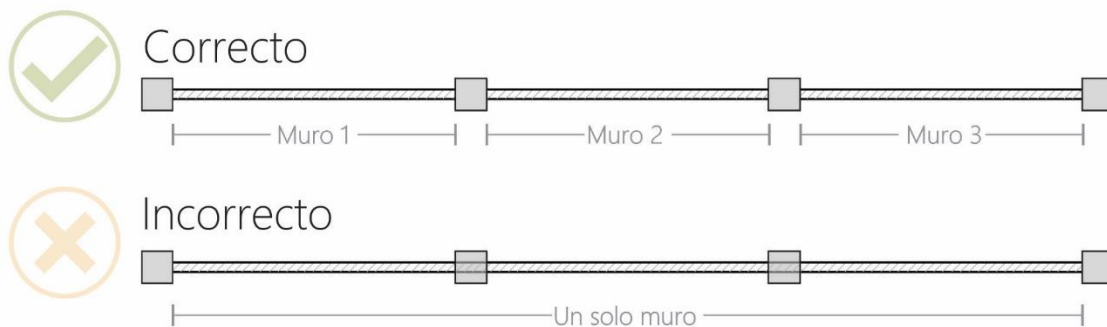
Vista en planta de ejemplo para modelado correcto de muros en encuentro con pilares.
